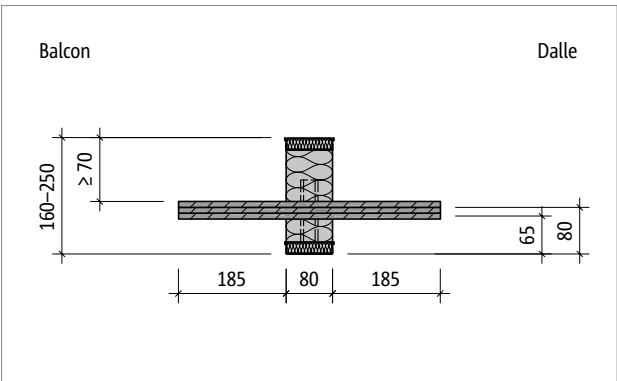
Schöck Isokorb® T Type H-VV1-NN1 : Coupe du produit
